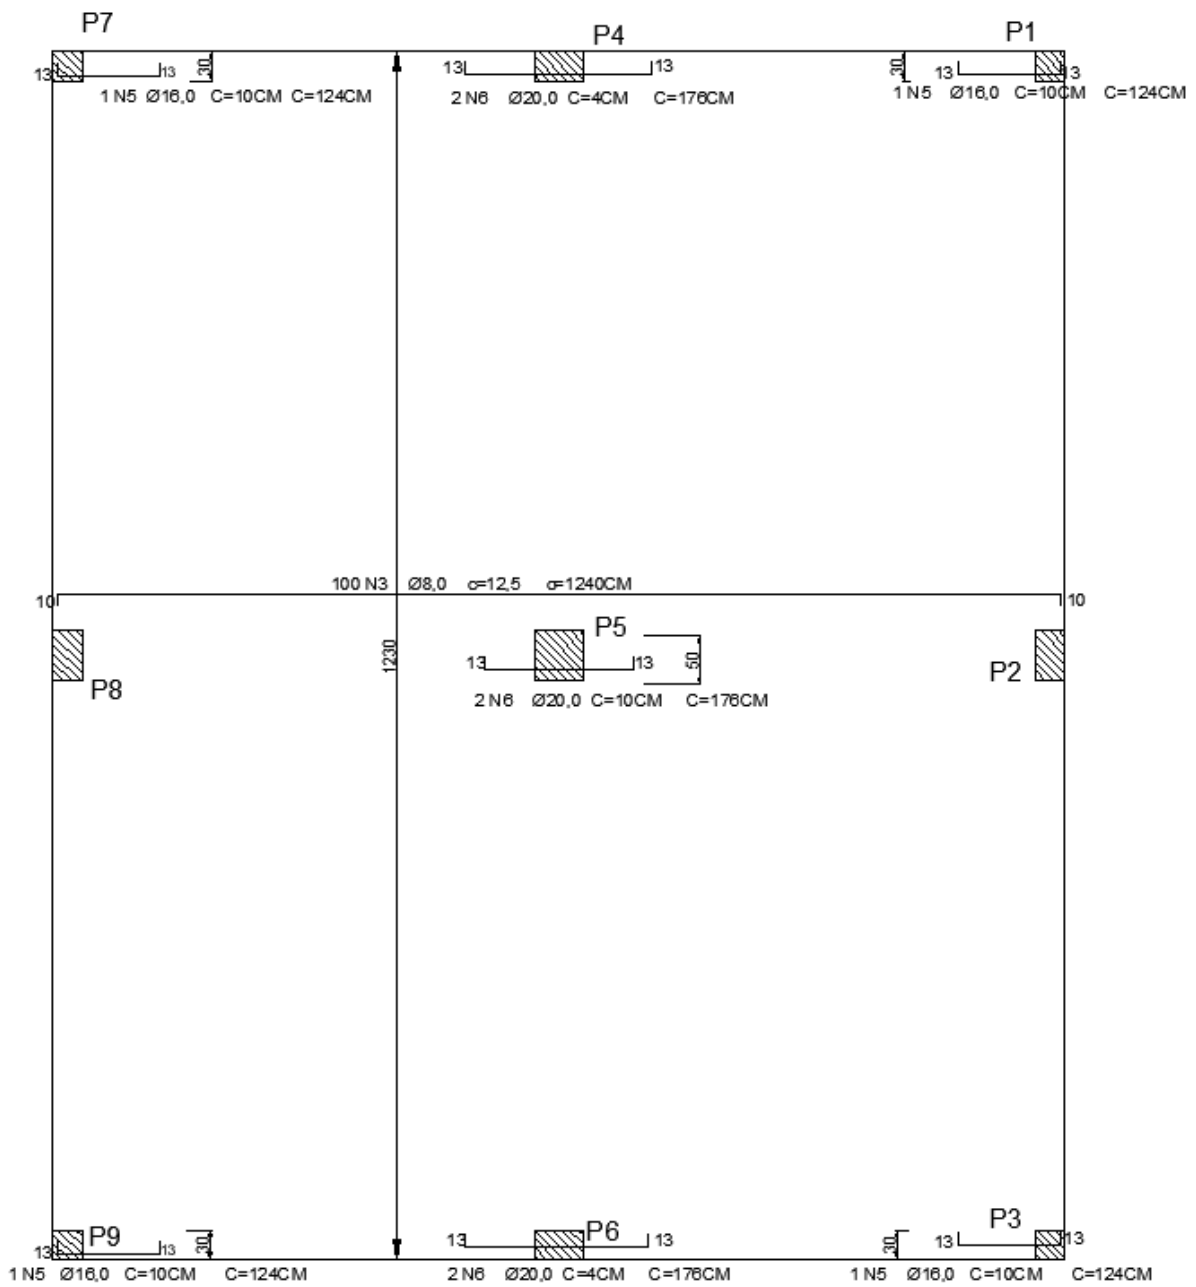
Armaduras inferiores na direção Y pela NBR 6118/2014
